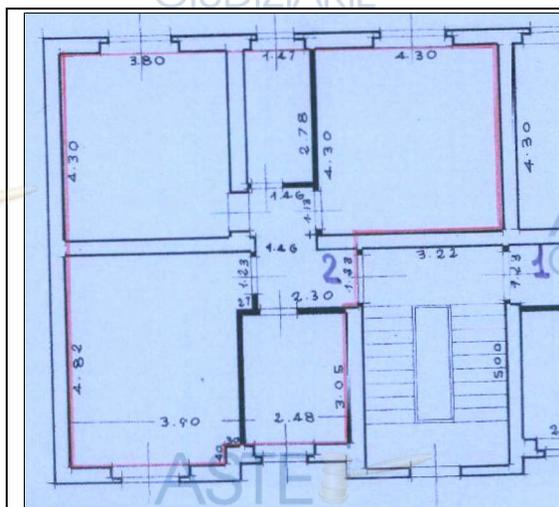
/a. Pianta allegata al contratto di cessione dell'alloggio.
